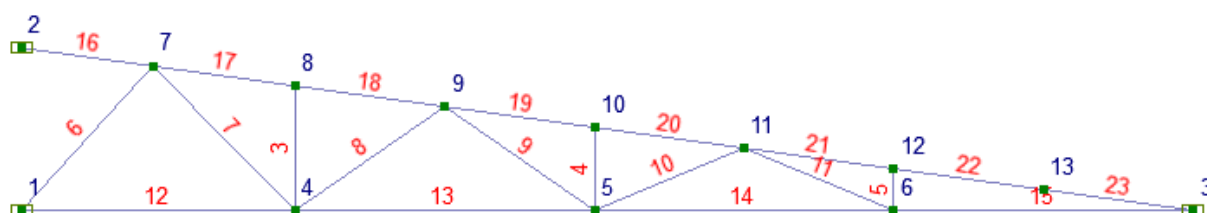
Конечно-элементная модель стропильной фермы Ф-1
